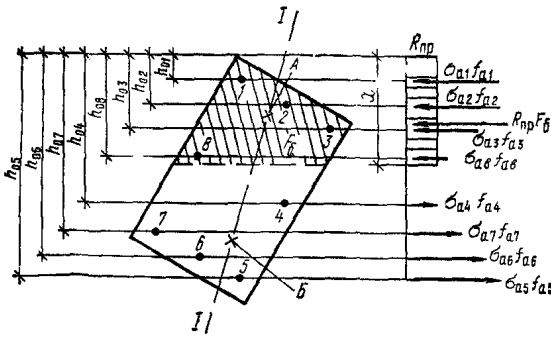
Схема усилий и эпюра напряжений в сечении, нормальном к продольной оси железобетонного элемента, в общем случае расчета по прочности
